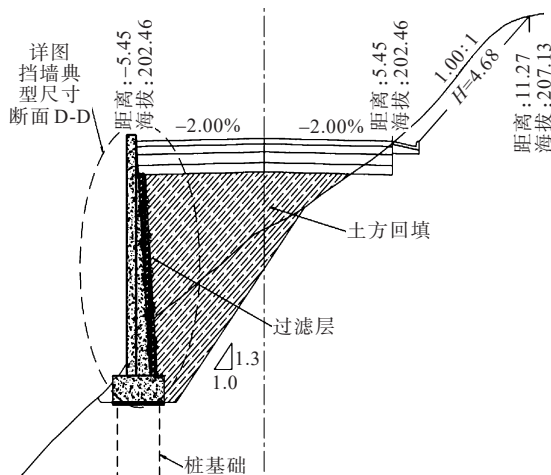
路堤钢筋混凝土挡土墙(桩基础)(单位:m)
